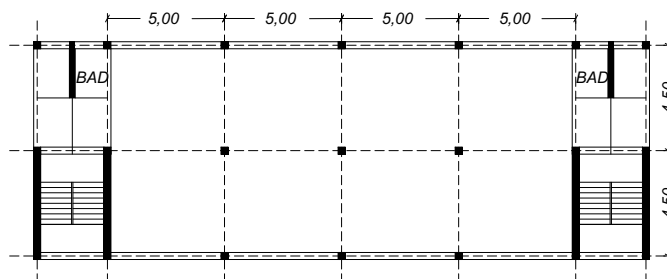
Bausystem mit Betonskelett, Typ C, Normalgeschoss (Adolf Rading 1927)
